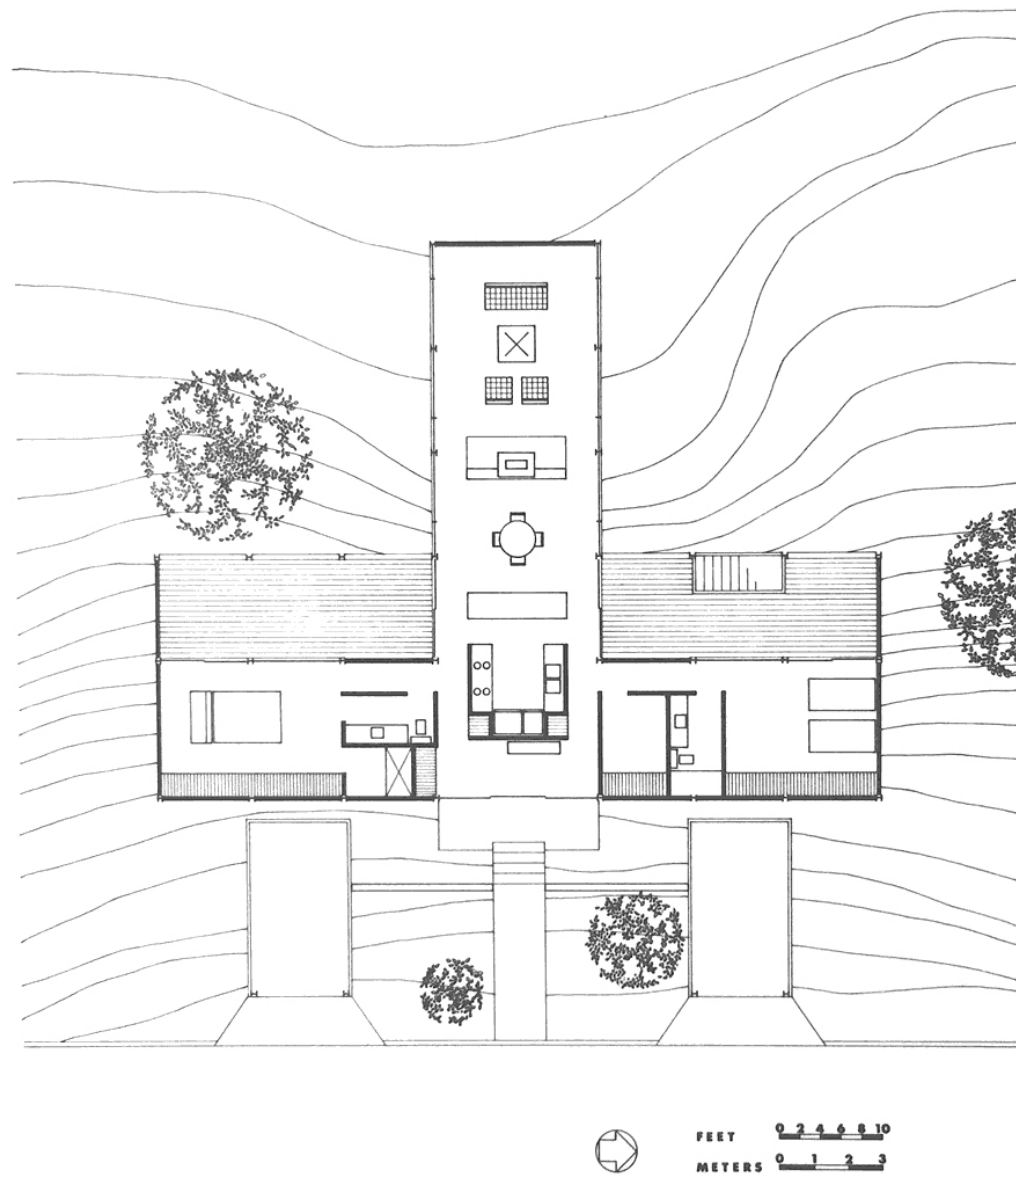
Craig Ellwood, Smith House (Glass House), LA, 1958, Grundriss
